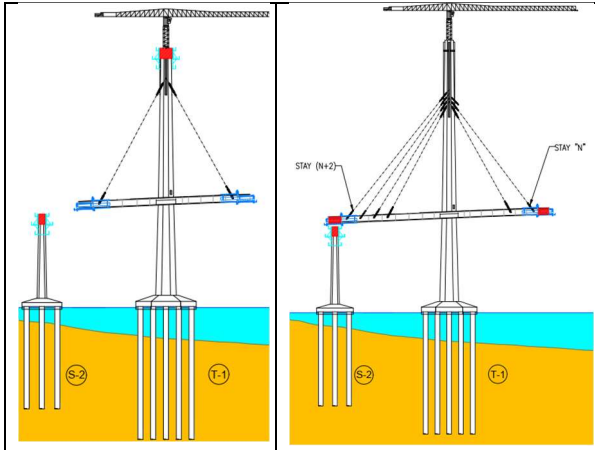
Desfase entre tirantes del vano principal y lateral durante el proceso constructivo.
